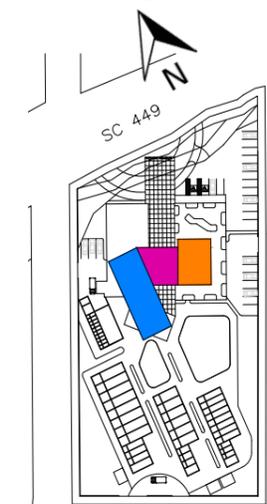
Planta Baixa Centro de Tratamento Veterinário
